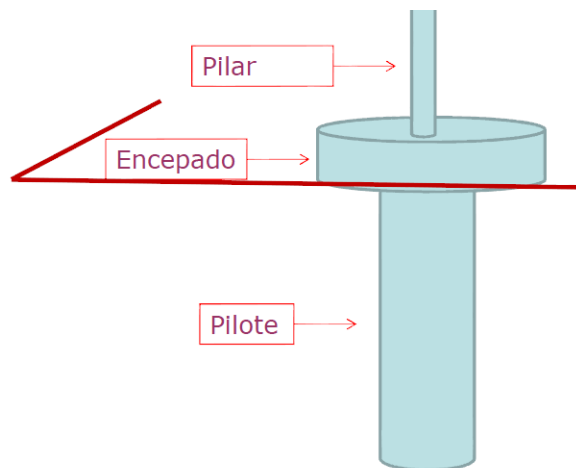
Ejemplo pilotes con encepado Fuente: asignatura “Tipología estructural”
